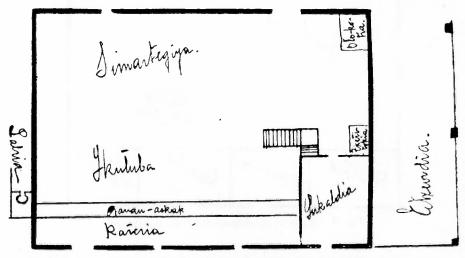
Caserío Arantzadi-txiki: planta baja.
